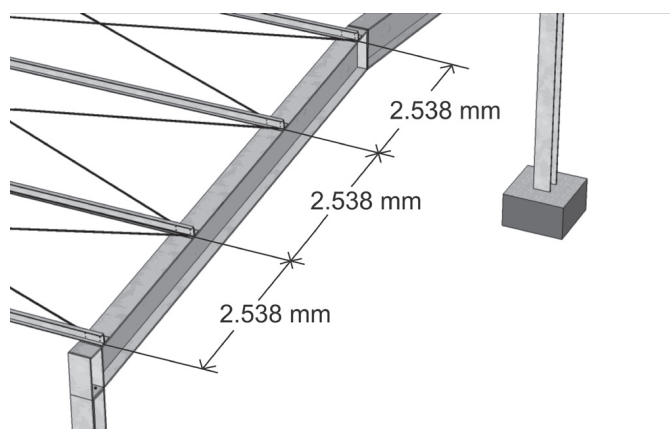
Espaçamento entre seções travadas no perfil da viga
